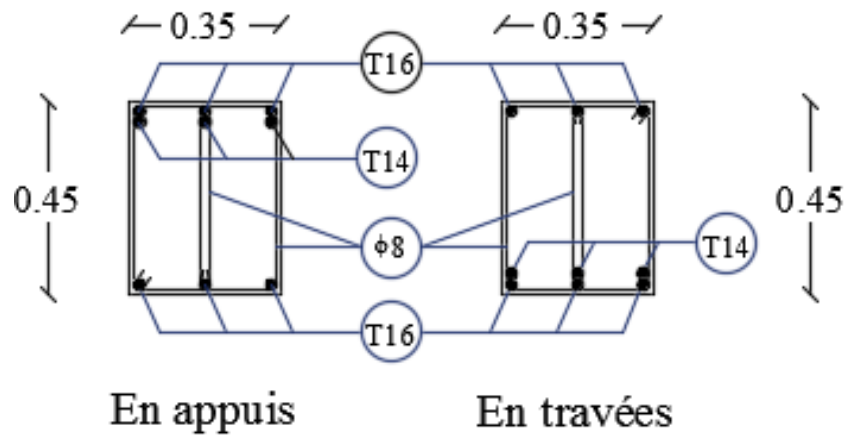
Ferrailage des poutres principales (bloc E1 & E2)
